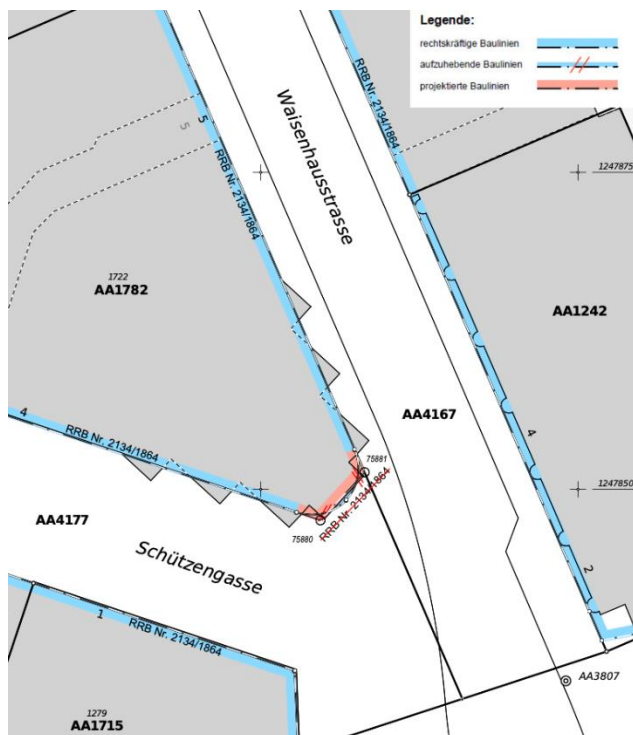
Baulinienanpassung im Abschnitt Schützengasse 4/Waisenhausstrasse 5
